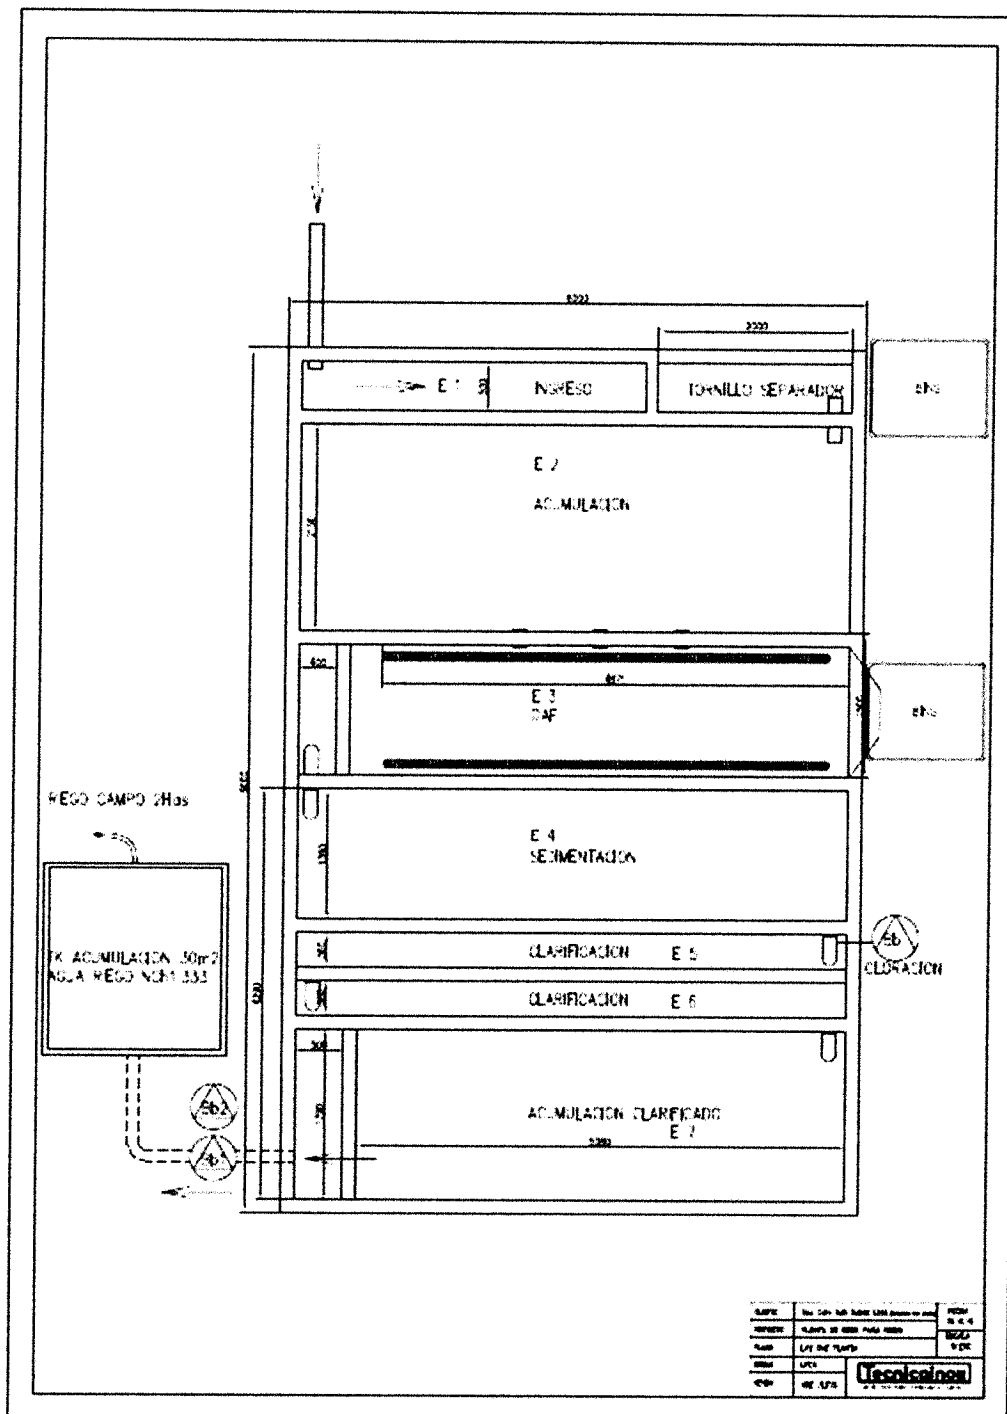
Layout de la planta de tratamiento de Riles de Matadero San Daniel.
